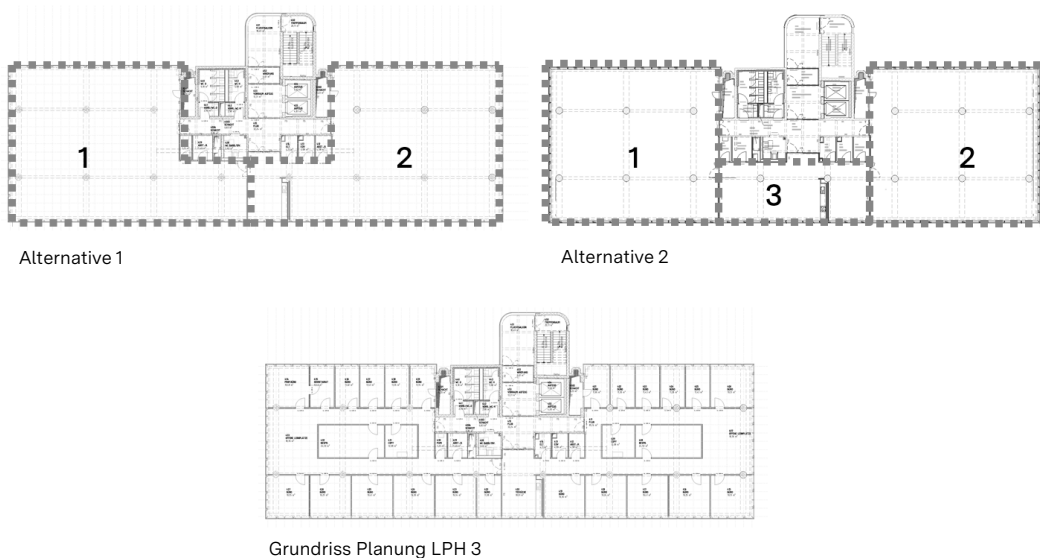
Entwicklung von zwei baulichen Alternativen (oben) aus dem Grundriss der LPH 3 (unten)
